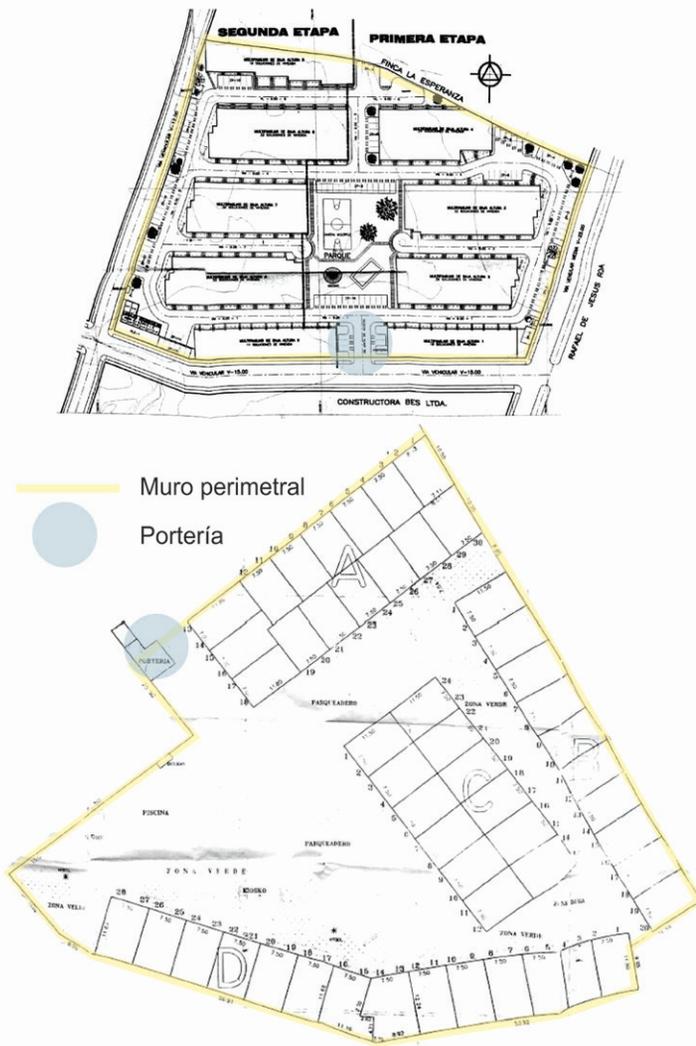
/ Planimetría para permiso de construcción de vivienda en conjunto cerrado (Década de 1980)
